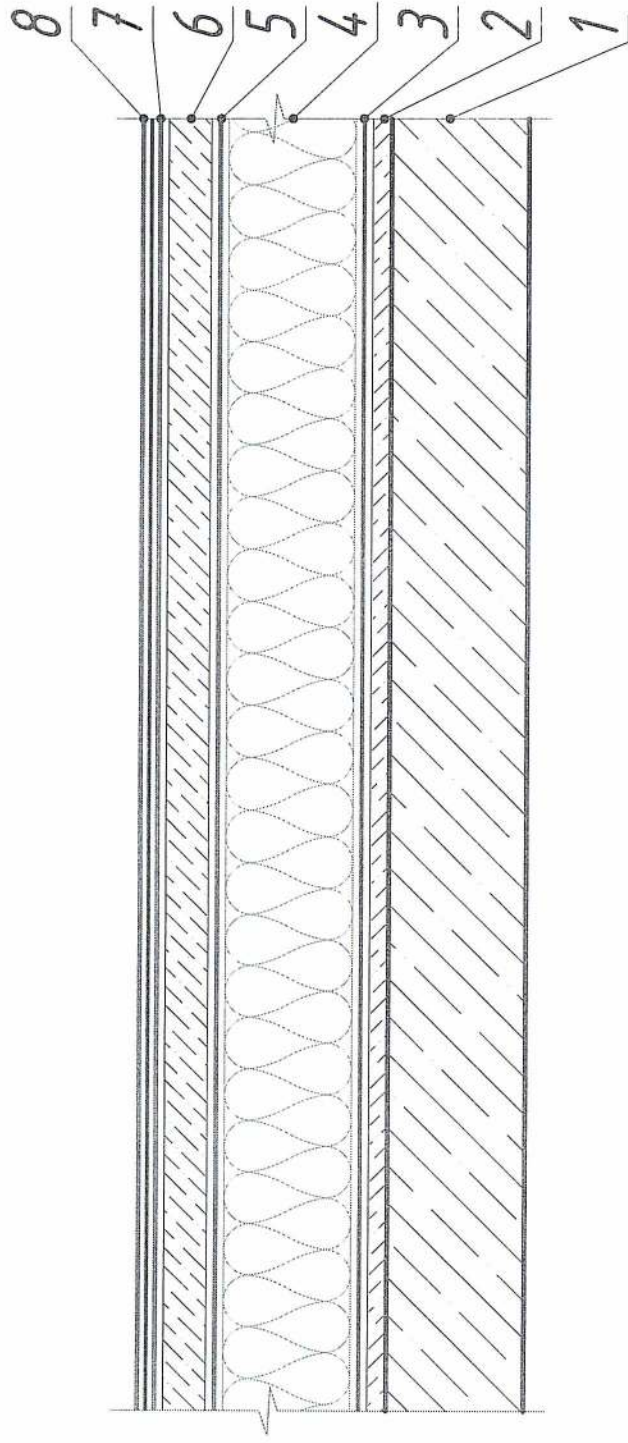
Принципиальная схема конструктивного исполнения настла бесчердачного покрытия выполняемого по железобетонному основанию (неэксплуатируемая кровля)
